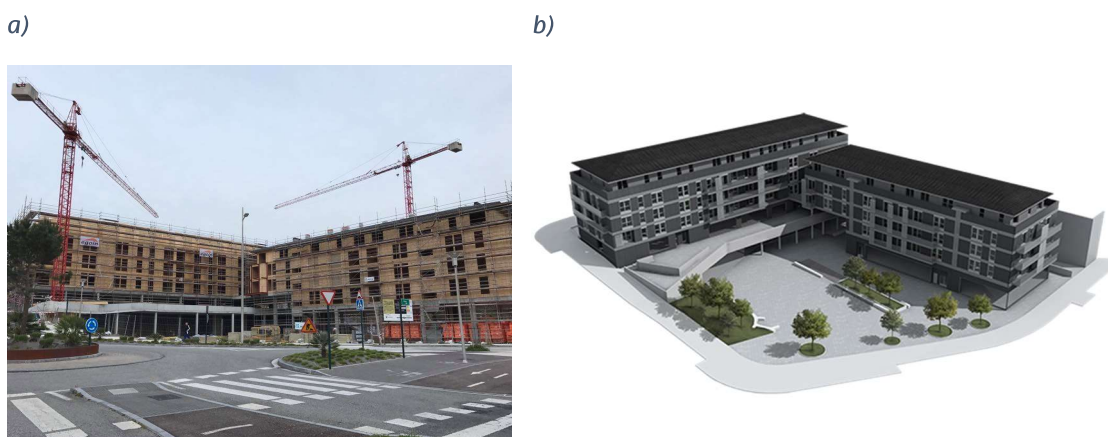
a) estado actual de proyecto de viviendas de VISESA; b) construcción proyectada de viviendas de VISESA
